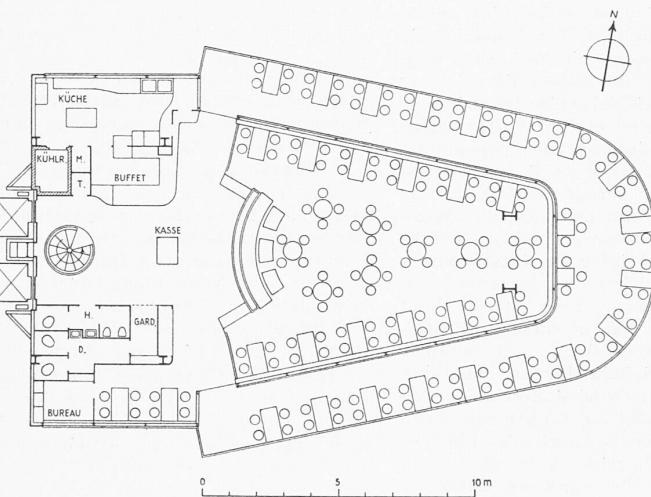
Turmrestaurant. — Alle Grundrisse 1:250
